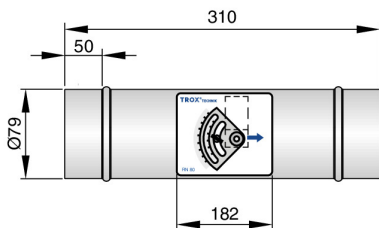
RN-A2 типоразмер 80, нержавеющая сталь
